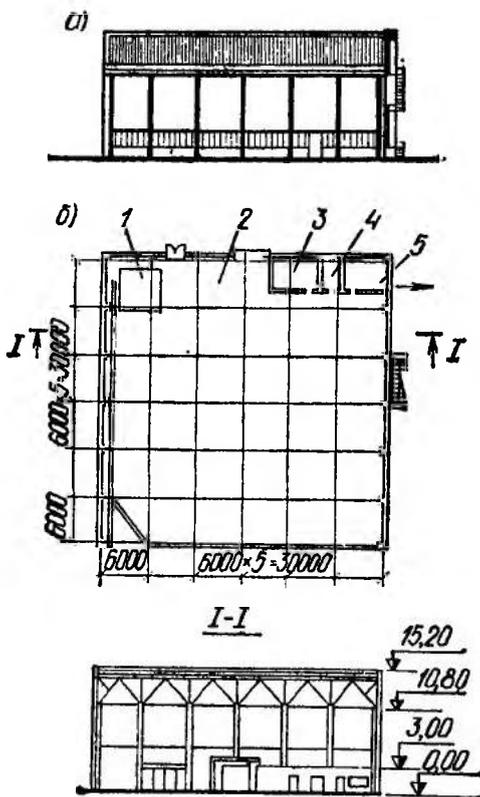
Ангар на один самолет типа АН-24 или ЯК-40
